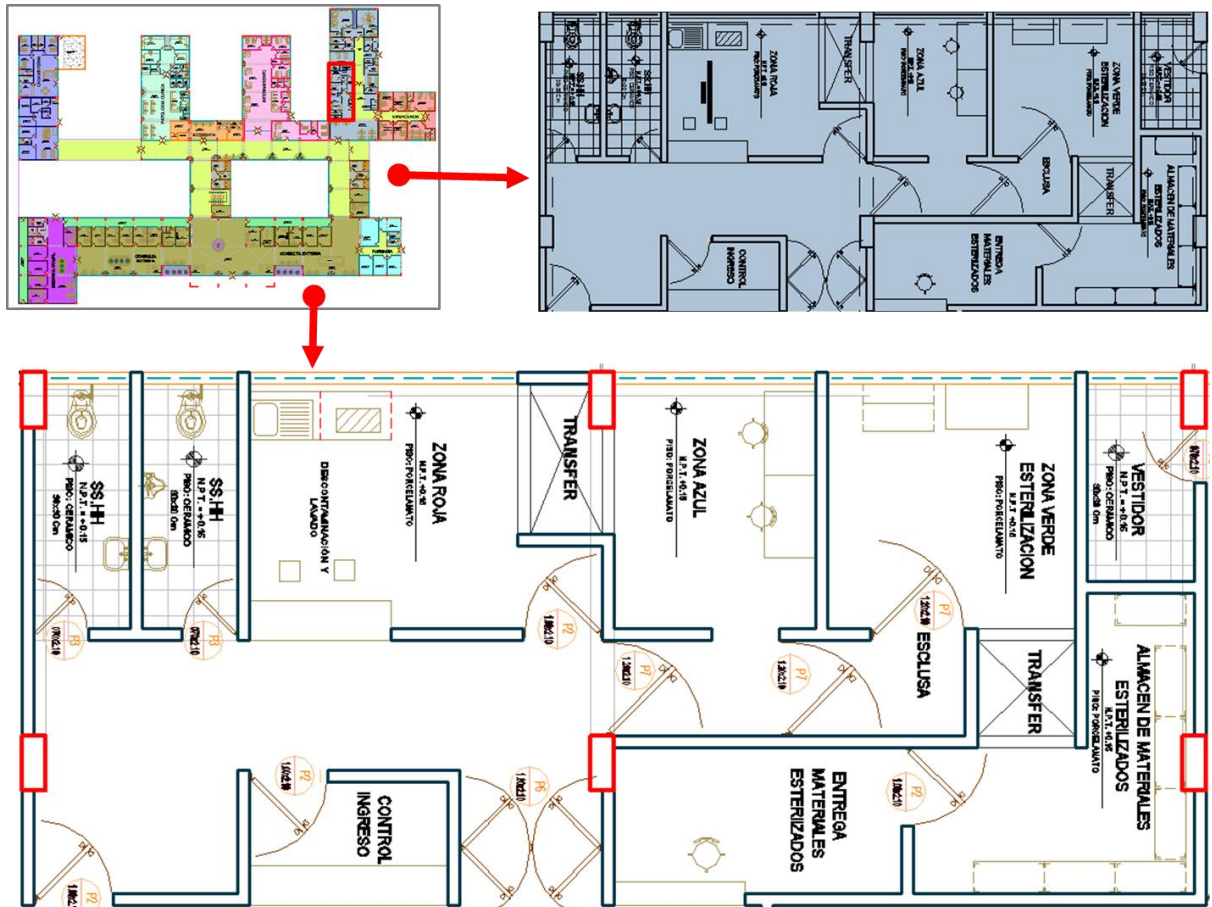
Unidad de Esterilización; Fuente: elaboración propia.
